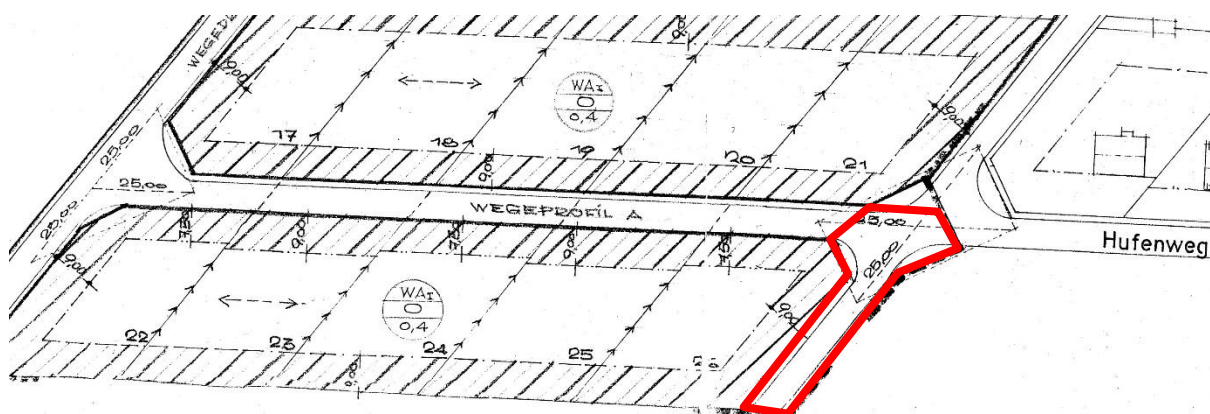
Auszug aus dem Bebauungsplan „Feldstraße“ mit Kennzeichnung des Änderungsbereiches (rote Linie) (ohne Maßstab).
